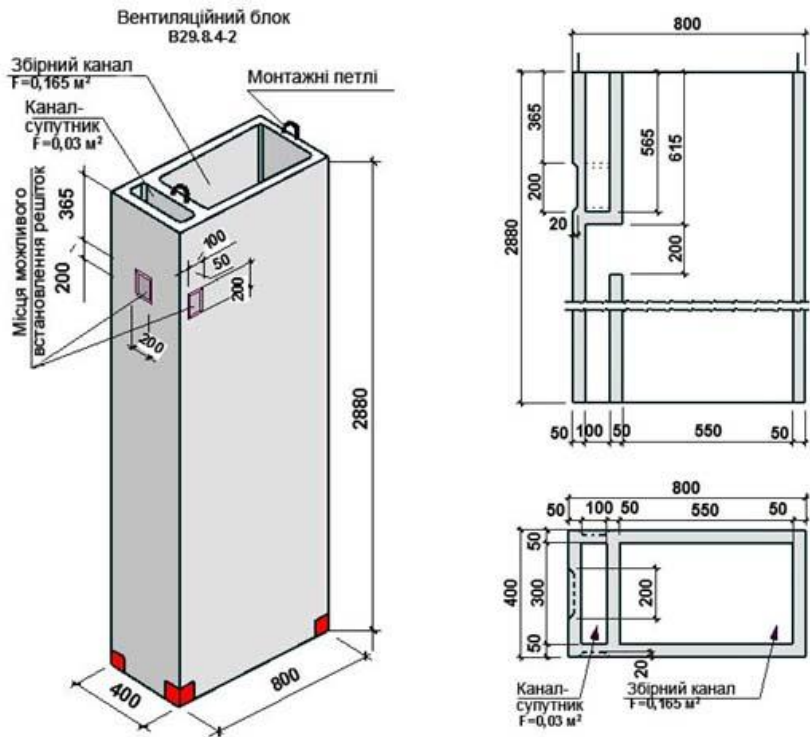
Уніфікований залізобетонний вентиляційний блок
